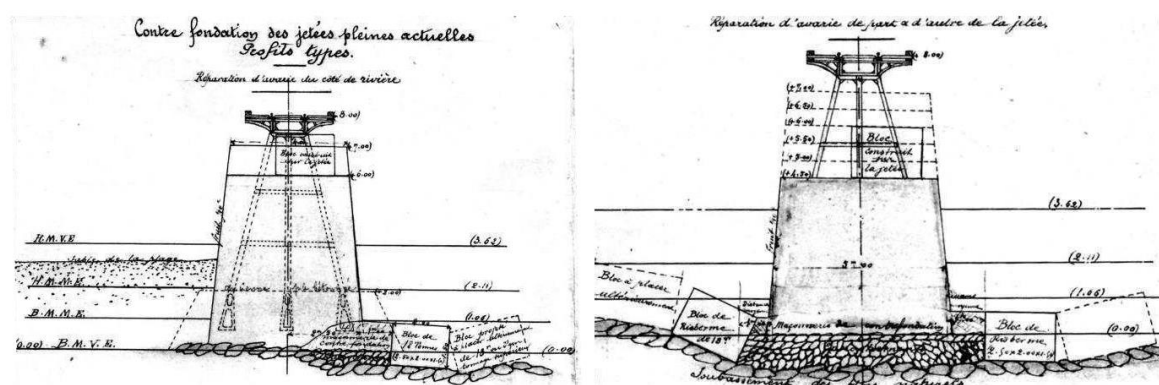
Coupe sur l'ouvrage en 1899 (PM 150 et 250)
